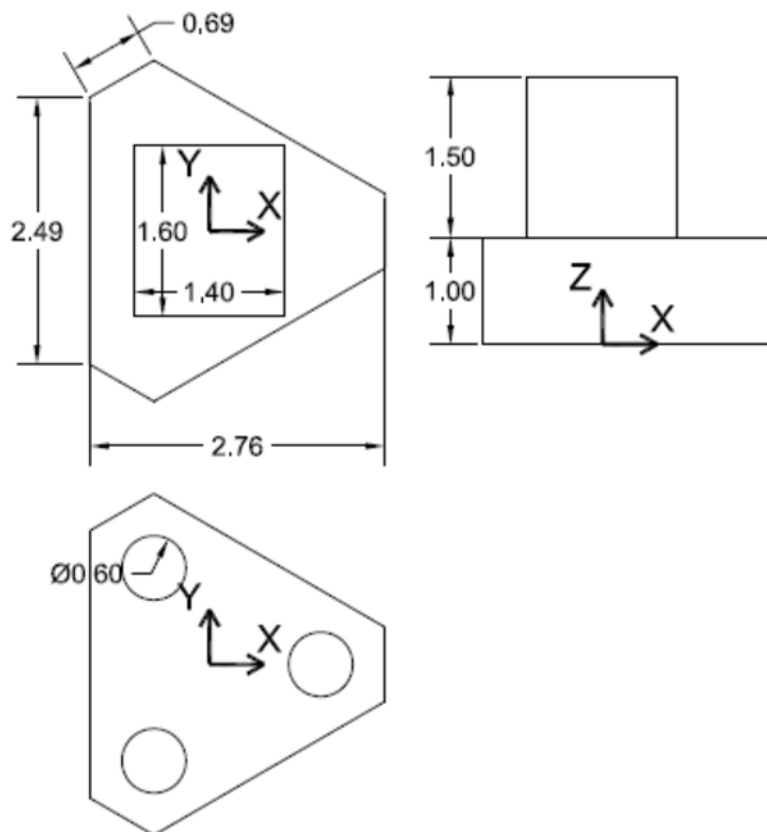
Carpenteria del plinto di fondazione - Posa su rilevato
